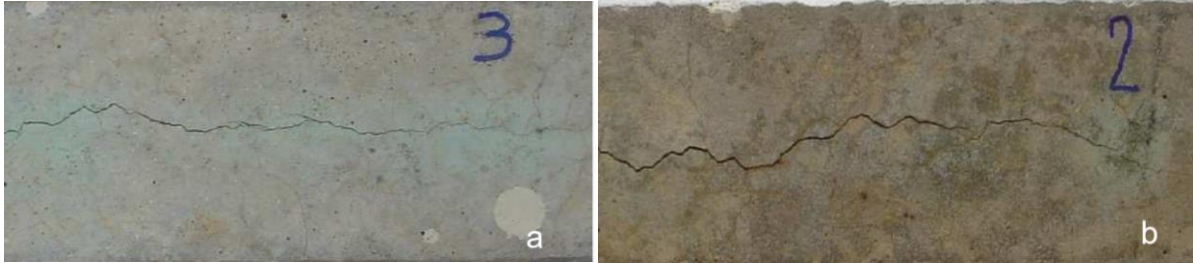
Vigas con contaminación inicial de cloruros, rociadas 25 cm en la zona central (a) sin precarga aplicada (b) con precarga aplicada
